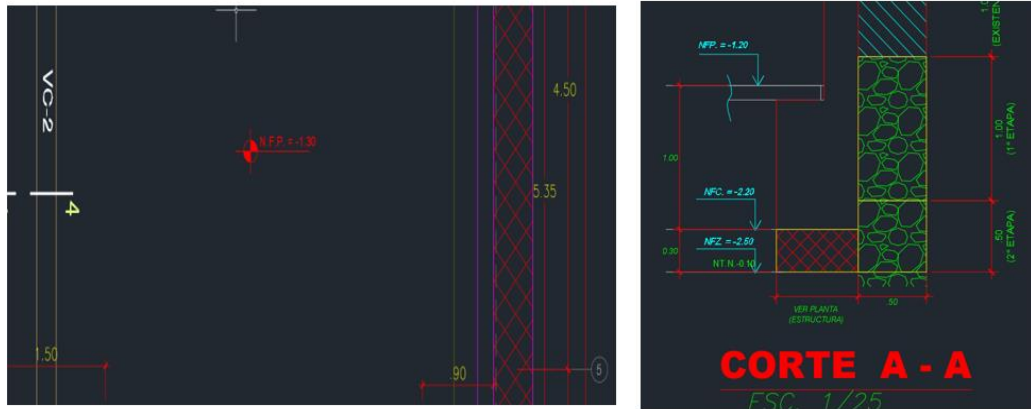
Nivel de falso piso diferente en planta y detalle.
